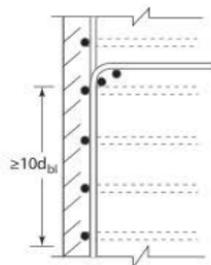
Nœud poteau-poutre de rive – Mise en place de coudes
